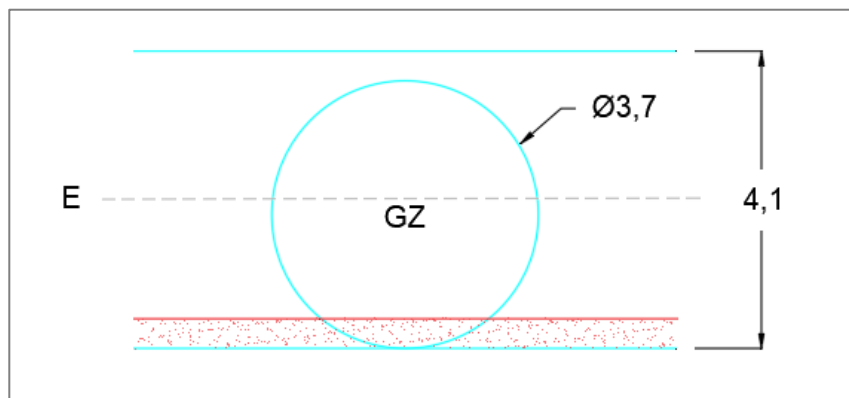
Intersección entre estocada y galería de zanja.
